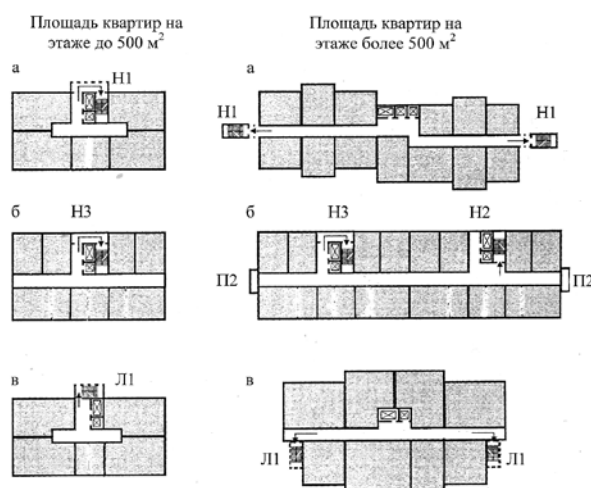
Схемы планировочных решений путей эвакуации: а – через закрытые лестницы с проходом через наружную зону; б – незадымляемые лестницы с подпором воздуха; в – лестницы с открытыми или остекленными проемами
